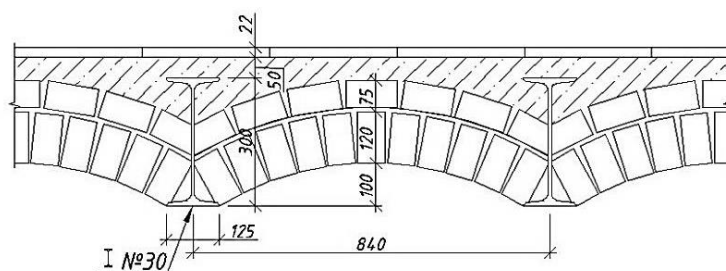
Конструктивное решение междуэтажного перекрытия корпуса Б
